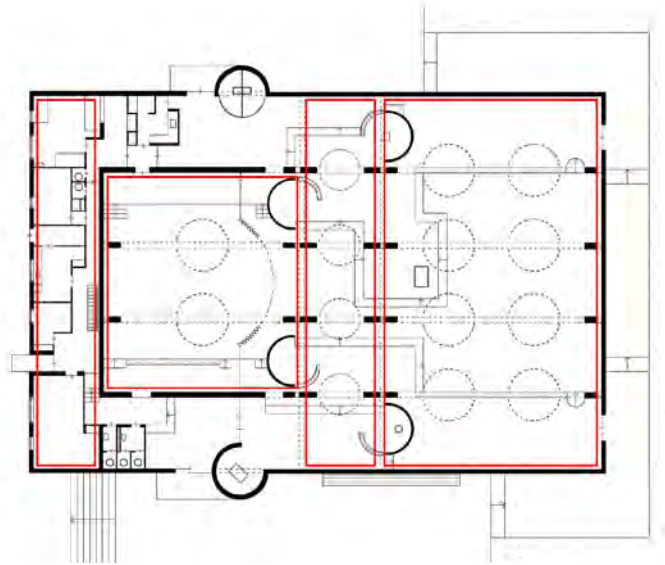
Dimensiones de la modulación de la planta de la iglesia (Nivel 3).
